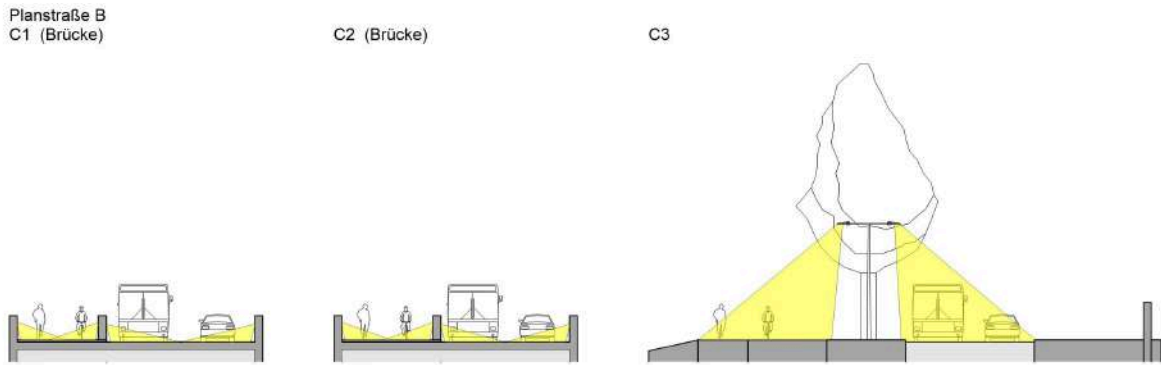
Schnitte C1 bis C3 der Planstraße B basierend auf dem städtebaulichen Entwurf
